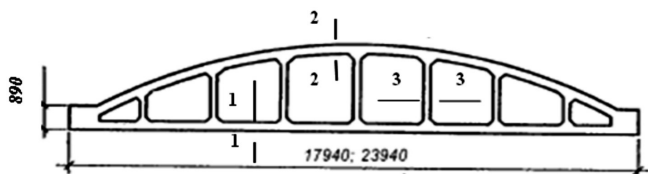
Конструкція аркової залізобетонної (бетон класу С32/40) безроскісної ферми (маса 6,5 т)
